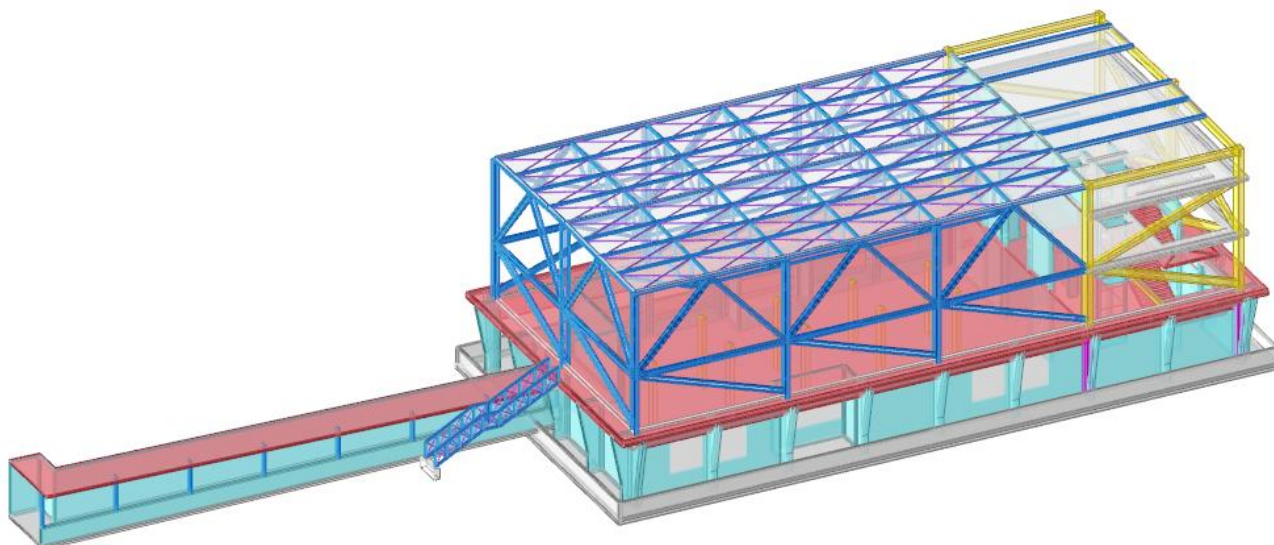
Vista 3D del Modello Strutturale FEM – Corpo A+B – Vista Assonometrica – Stato di Progetto
